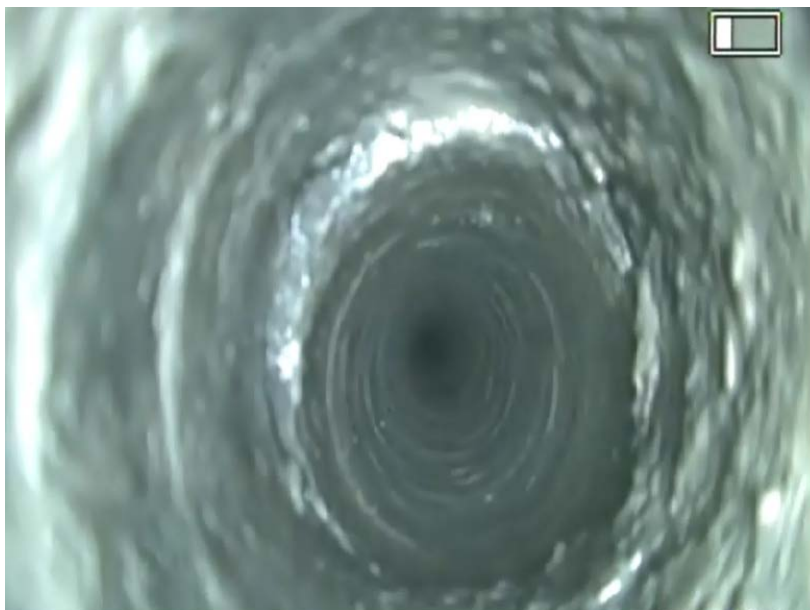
Зона расслоения пород кровли на глубине от 4,7 м до 4,8 м
